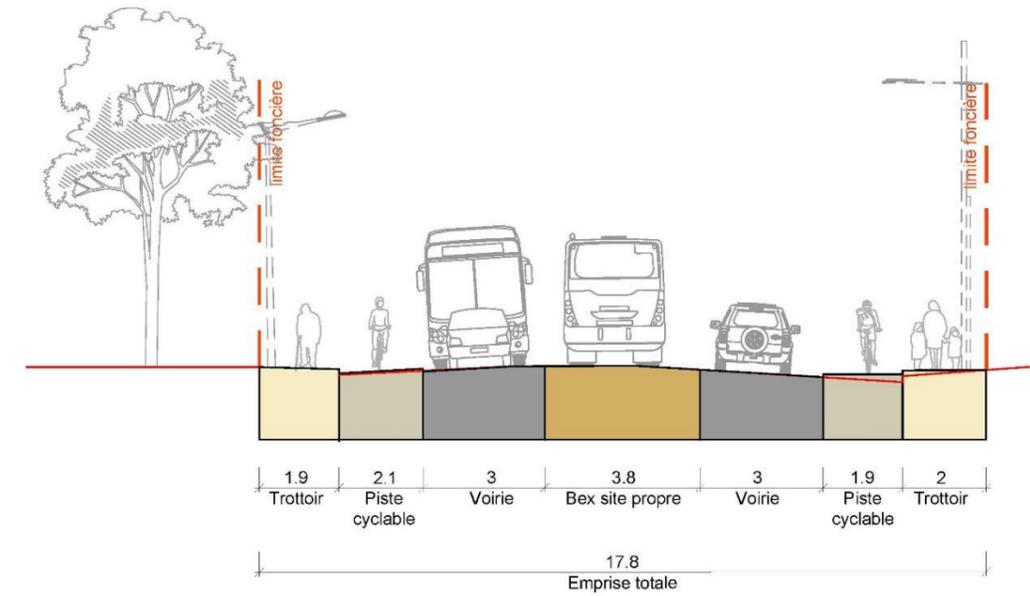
Coupe type sur la rue de la Croix de Monjous
